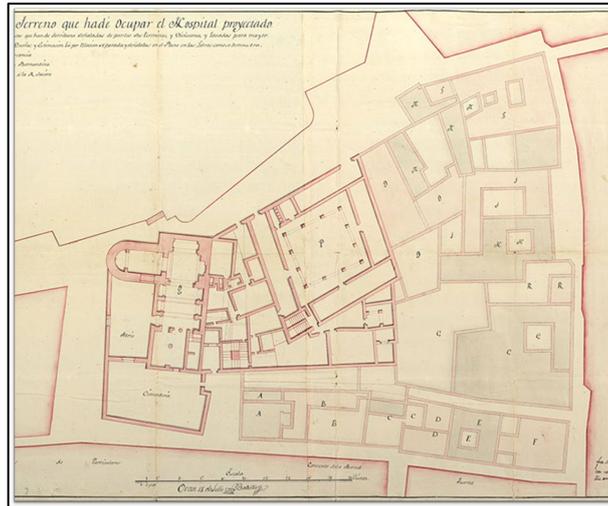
Plan des parcelles situées sur l'emprise de l'hôpital projeté par Juan Ballester, 1737.
